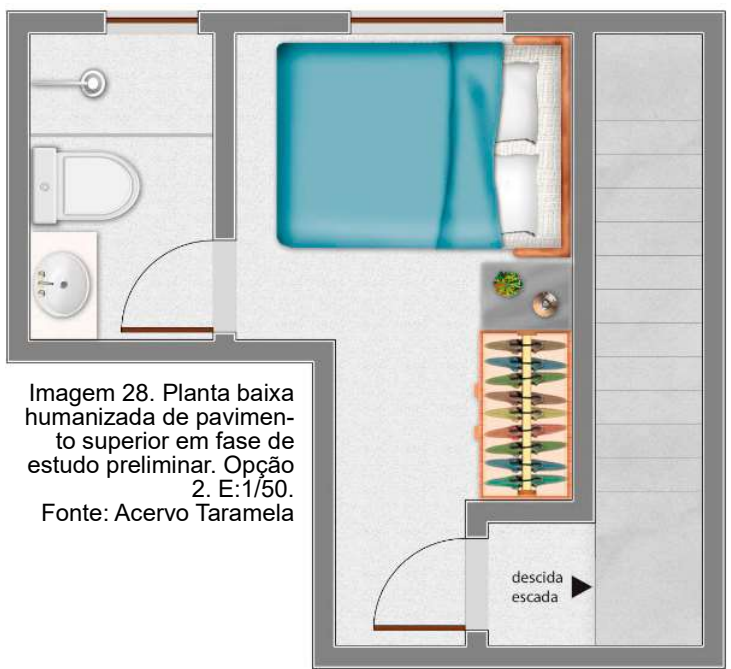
Planta baixa humanizada de pavimento superior em fase de estudo preliminar. Opção 2. E:1/50. Fonte: Acervo Taramela
